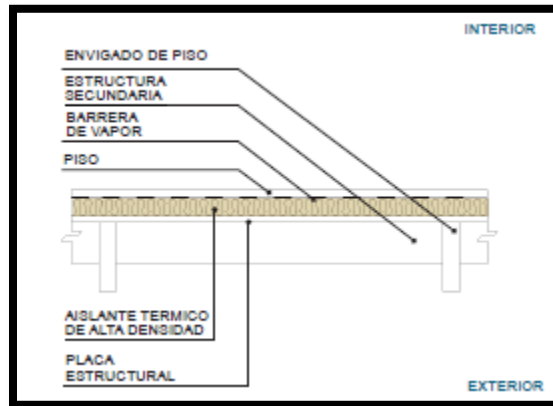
Piso con vigas ventilado. Barrera de vapor y aislante térmico por el interior.
